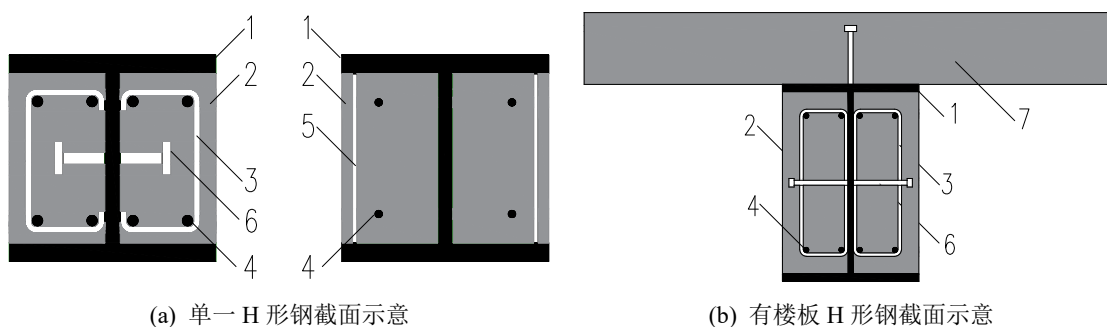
部分填充钢-混凝土组合构件的截面形式
